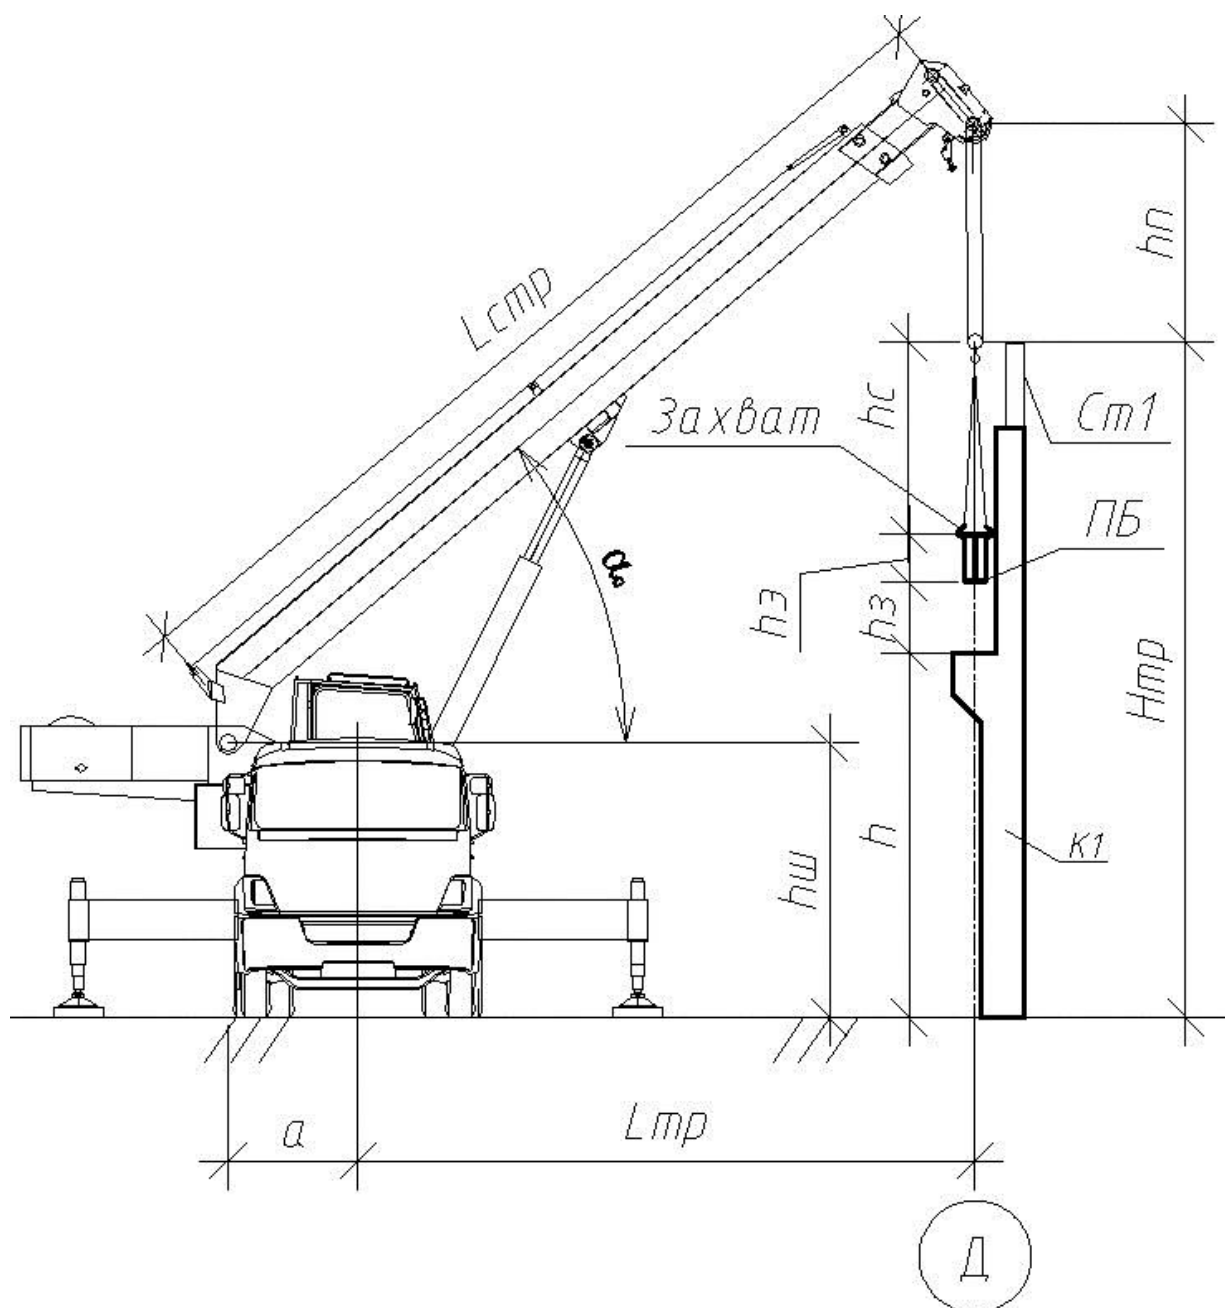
Расчетная схема к определению $H_{мп}$, $L_{стр}$, $L_{мп}$ при монтаже подкрановых балок
